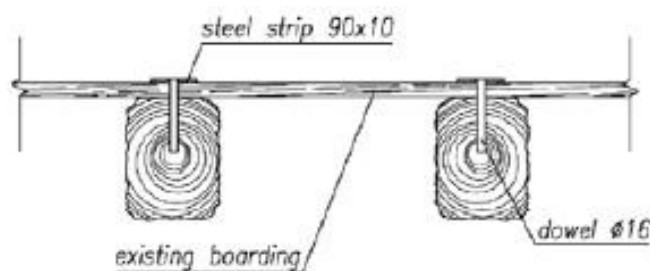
Colocação de chapas metálicas sobre as vigas (Gattesco et al.;2006).
